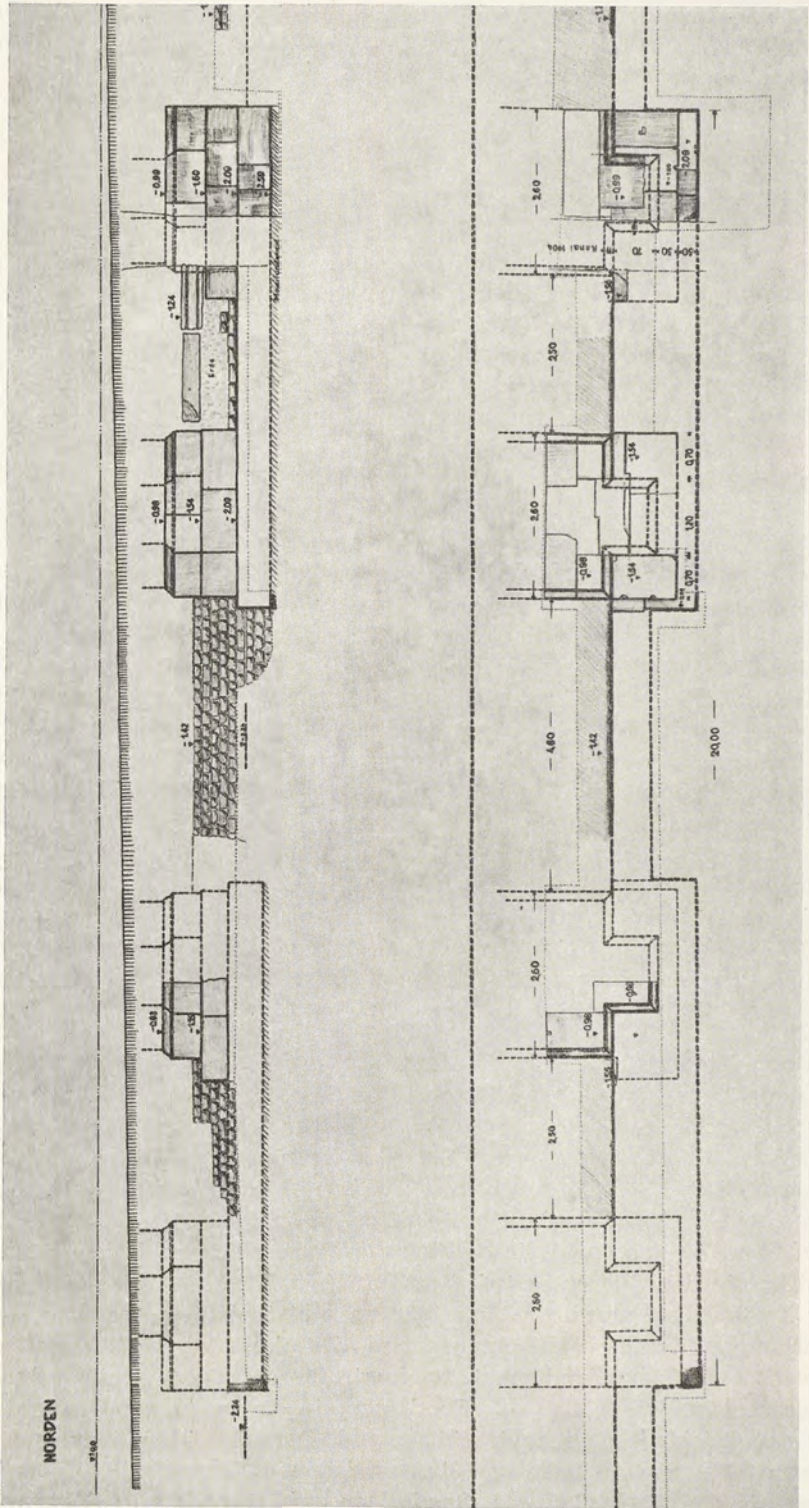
Mittlerer Teil der Westfassade der Kaiserthermen. Ansicht und Grundriß
